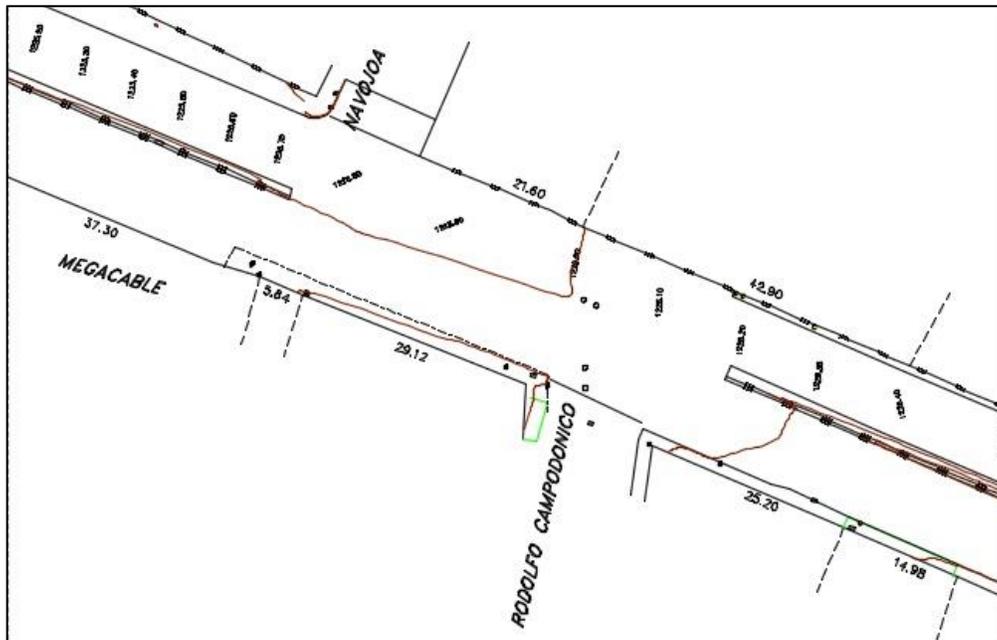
Plano Área de Estudio. Tramo Calle Navojoa – Calle Rodolfo Campodónico.
